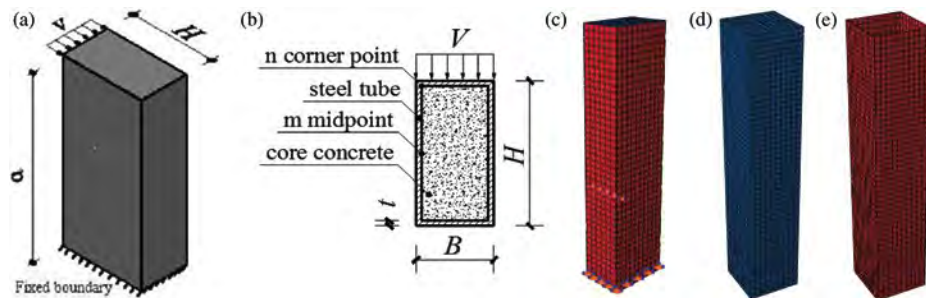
Schematisering staal-betonkolom en het opgestelde eindige-elementenmodel (volledig, betonkern en stalen buis)
